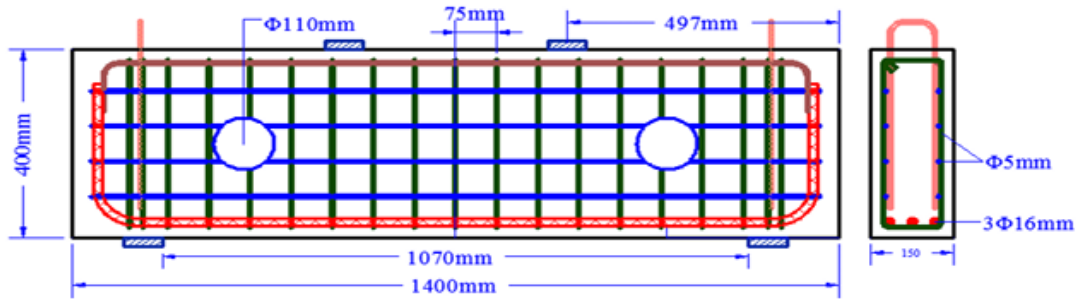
Geometria e armaduras da viga-parede (Al-Bayati *et al.*, 2018)
